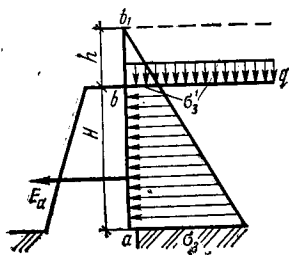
Определение активного давления грунта на подпорную стенку при наличии нагрузки на поверхности засыпки
